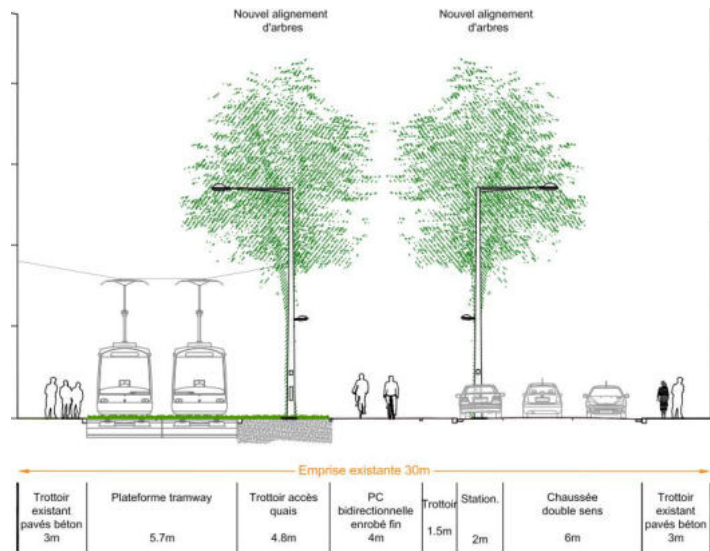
COUPE ET PLAN BLD WILSON _ SECTION ENTRE LA RUE DU FAUBOURG DE SAVERNE ET LA RUE DE BOUXWILLER
